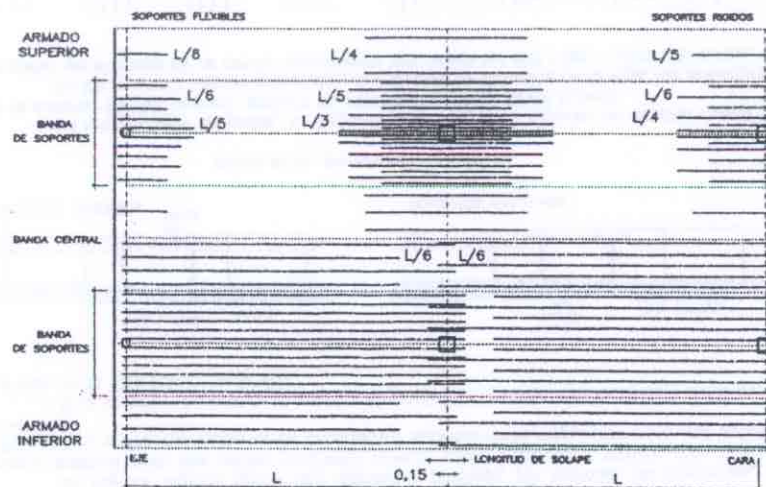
Despiece de armaduras en losas con soportes aislados
